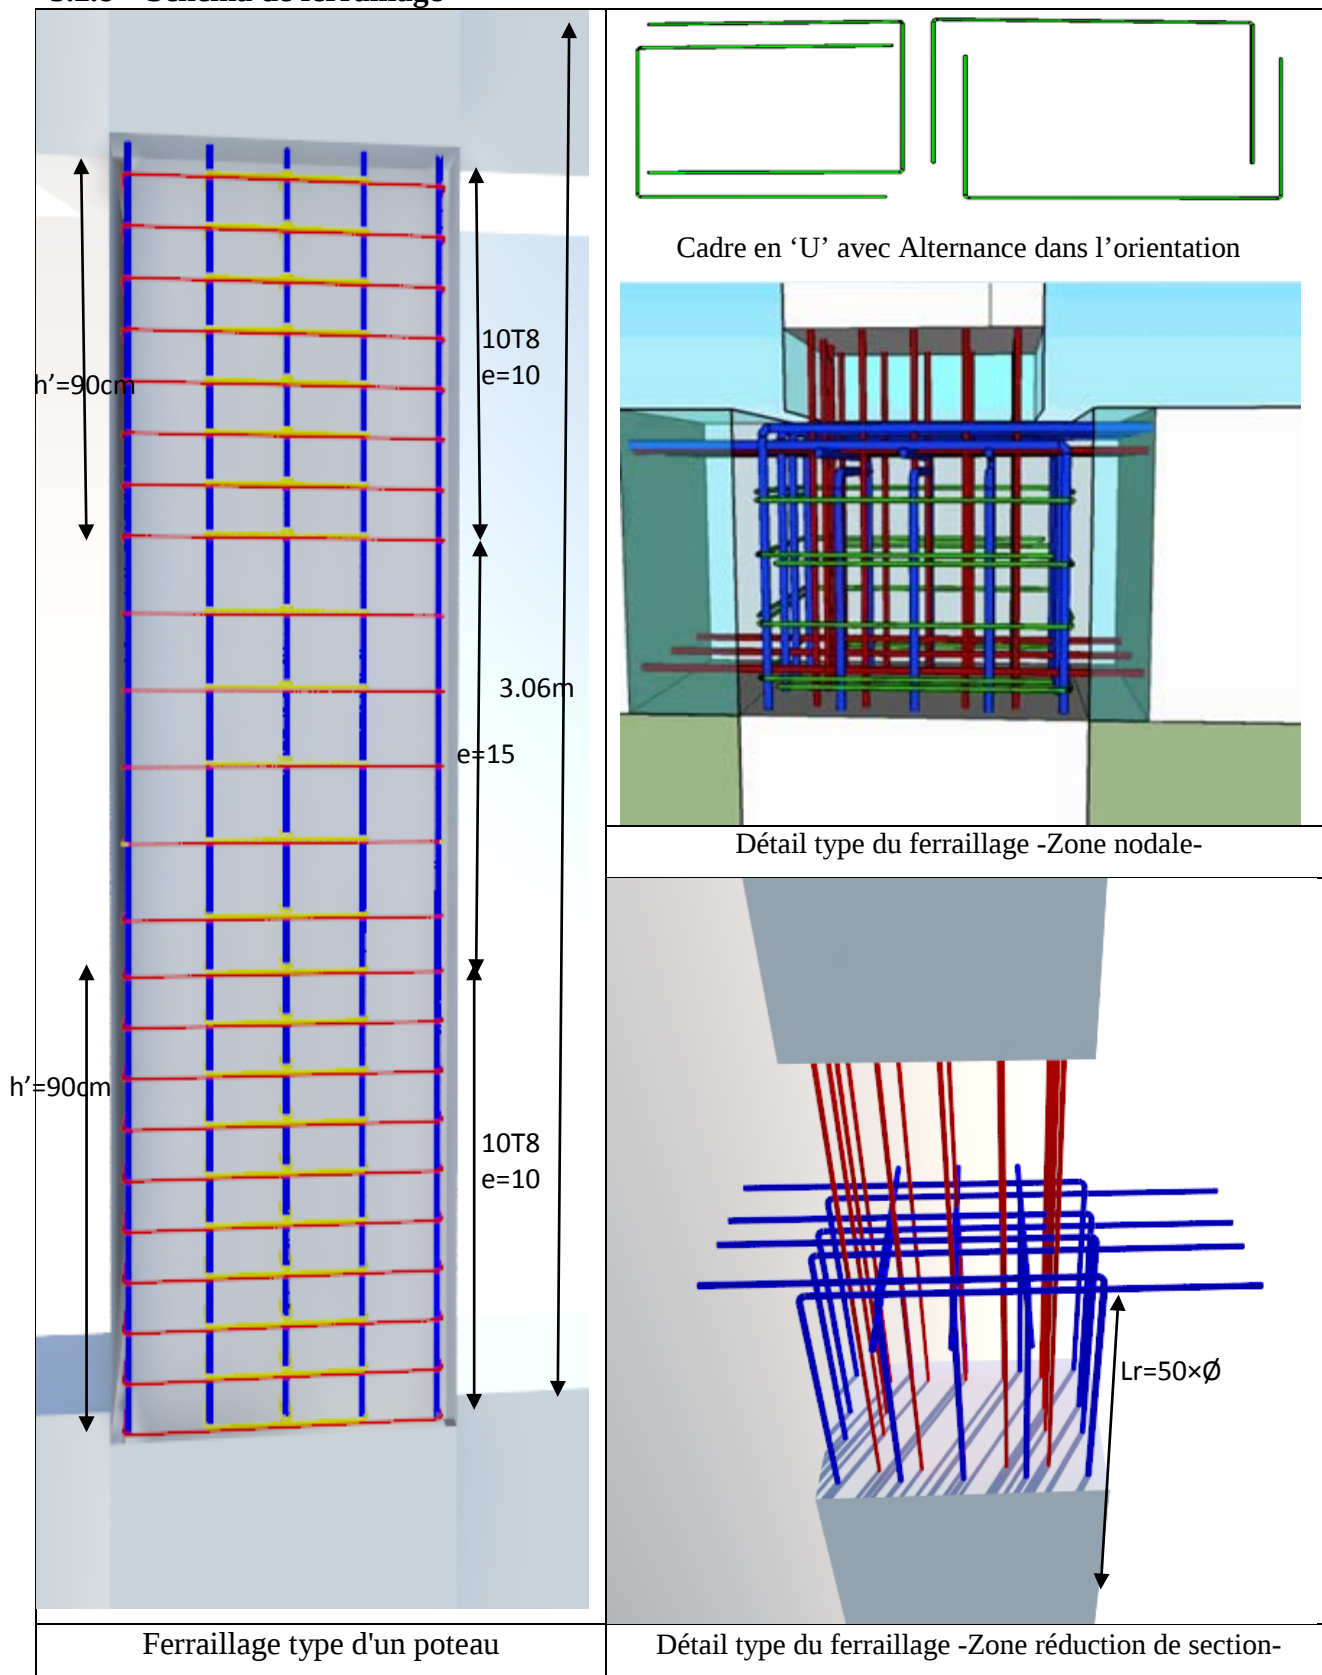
Exemple de Ferraillages des poteaux (Coupe verticale).
